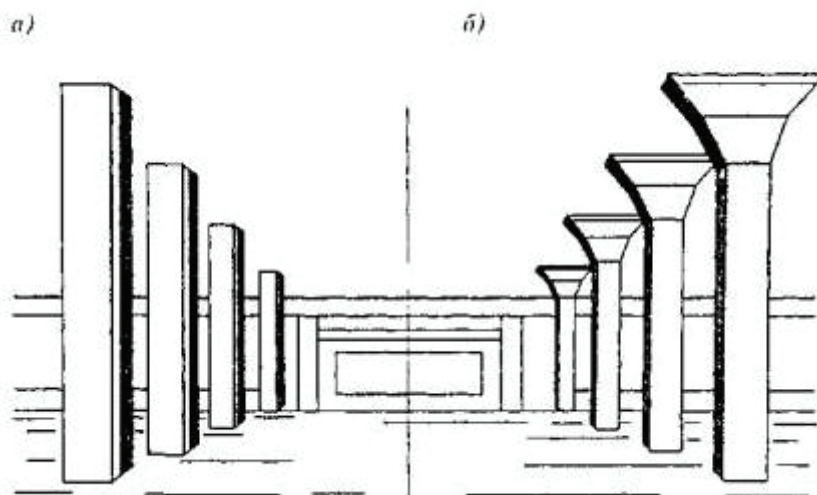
Монолитное безбалочное перекрытие а) без капители; б) с капителью [1]
